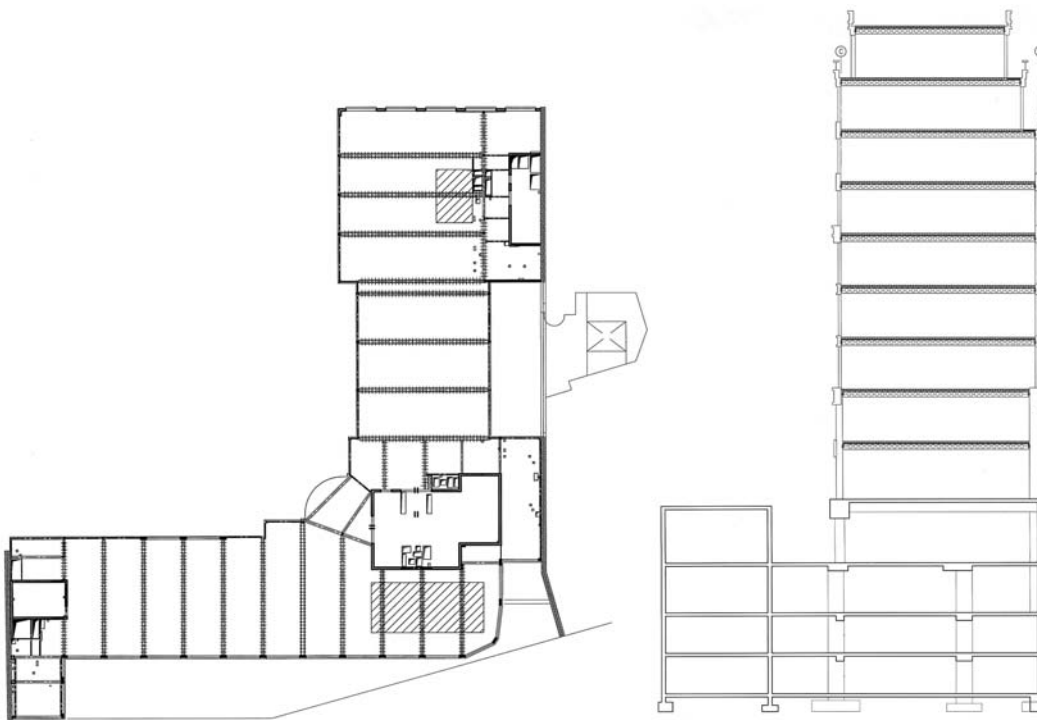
Vista en planta y sección transversal del edificio, donde se muestra las vigas de grandes luces
